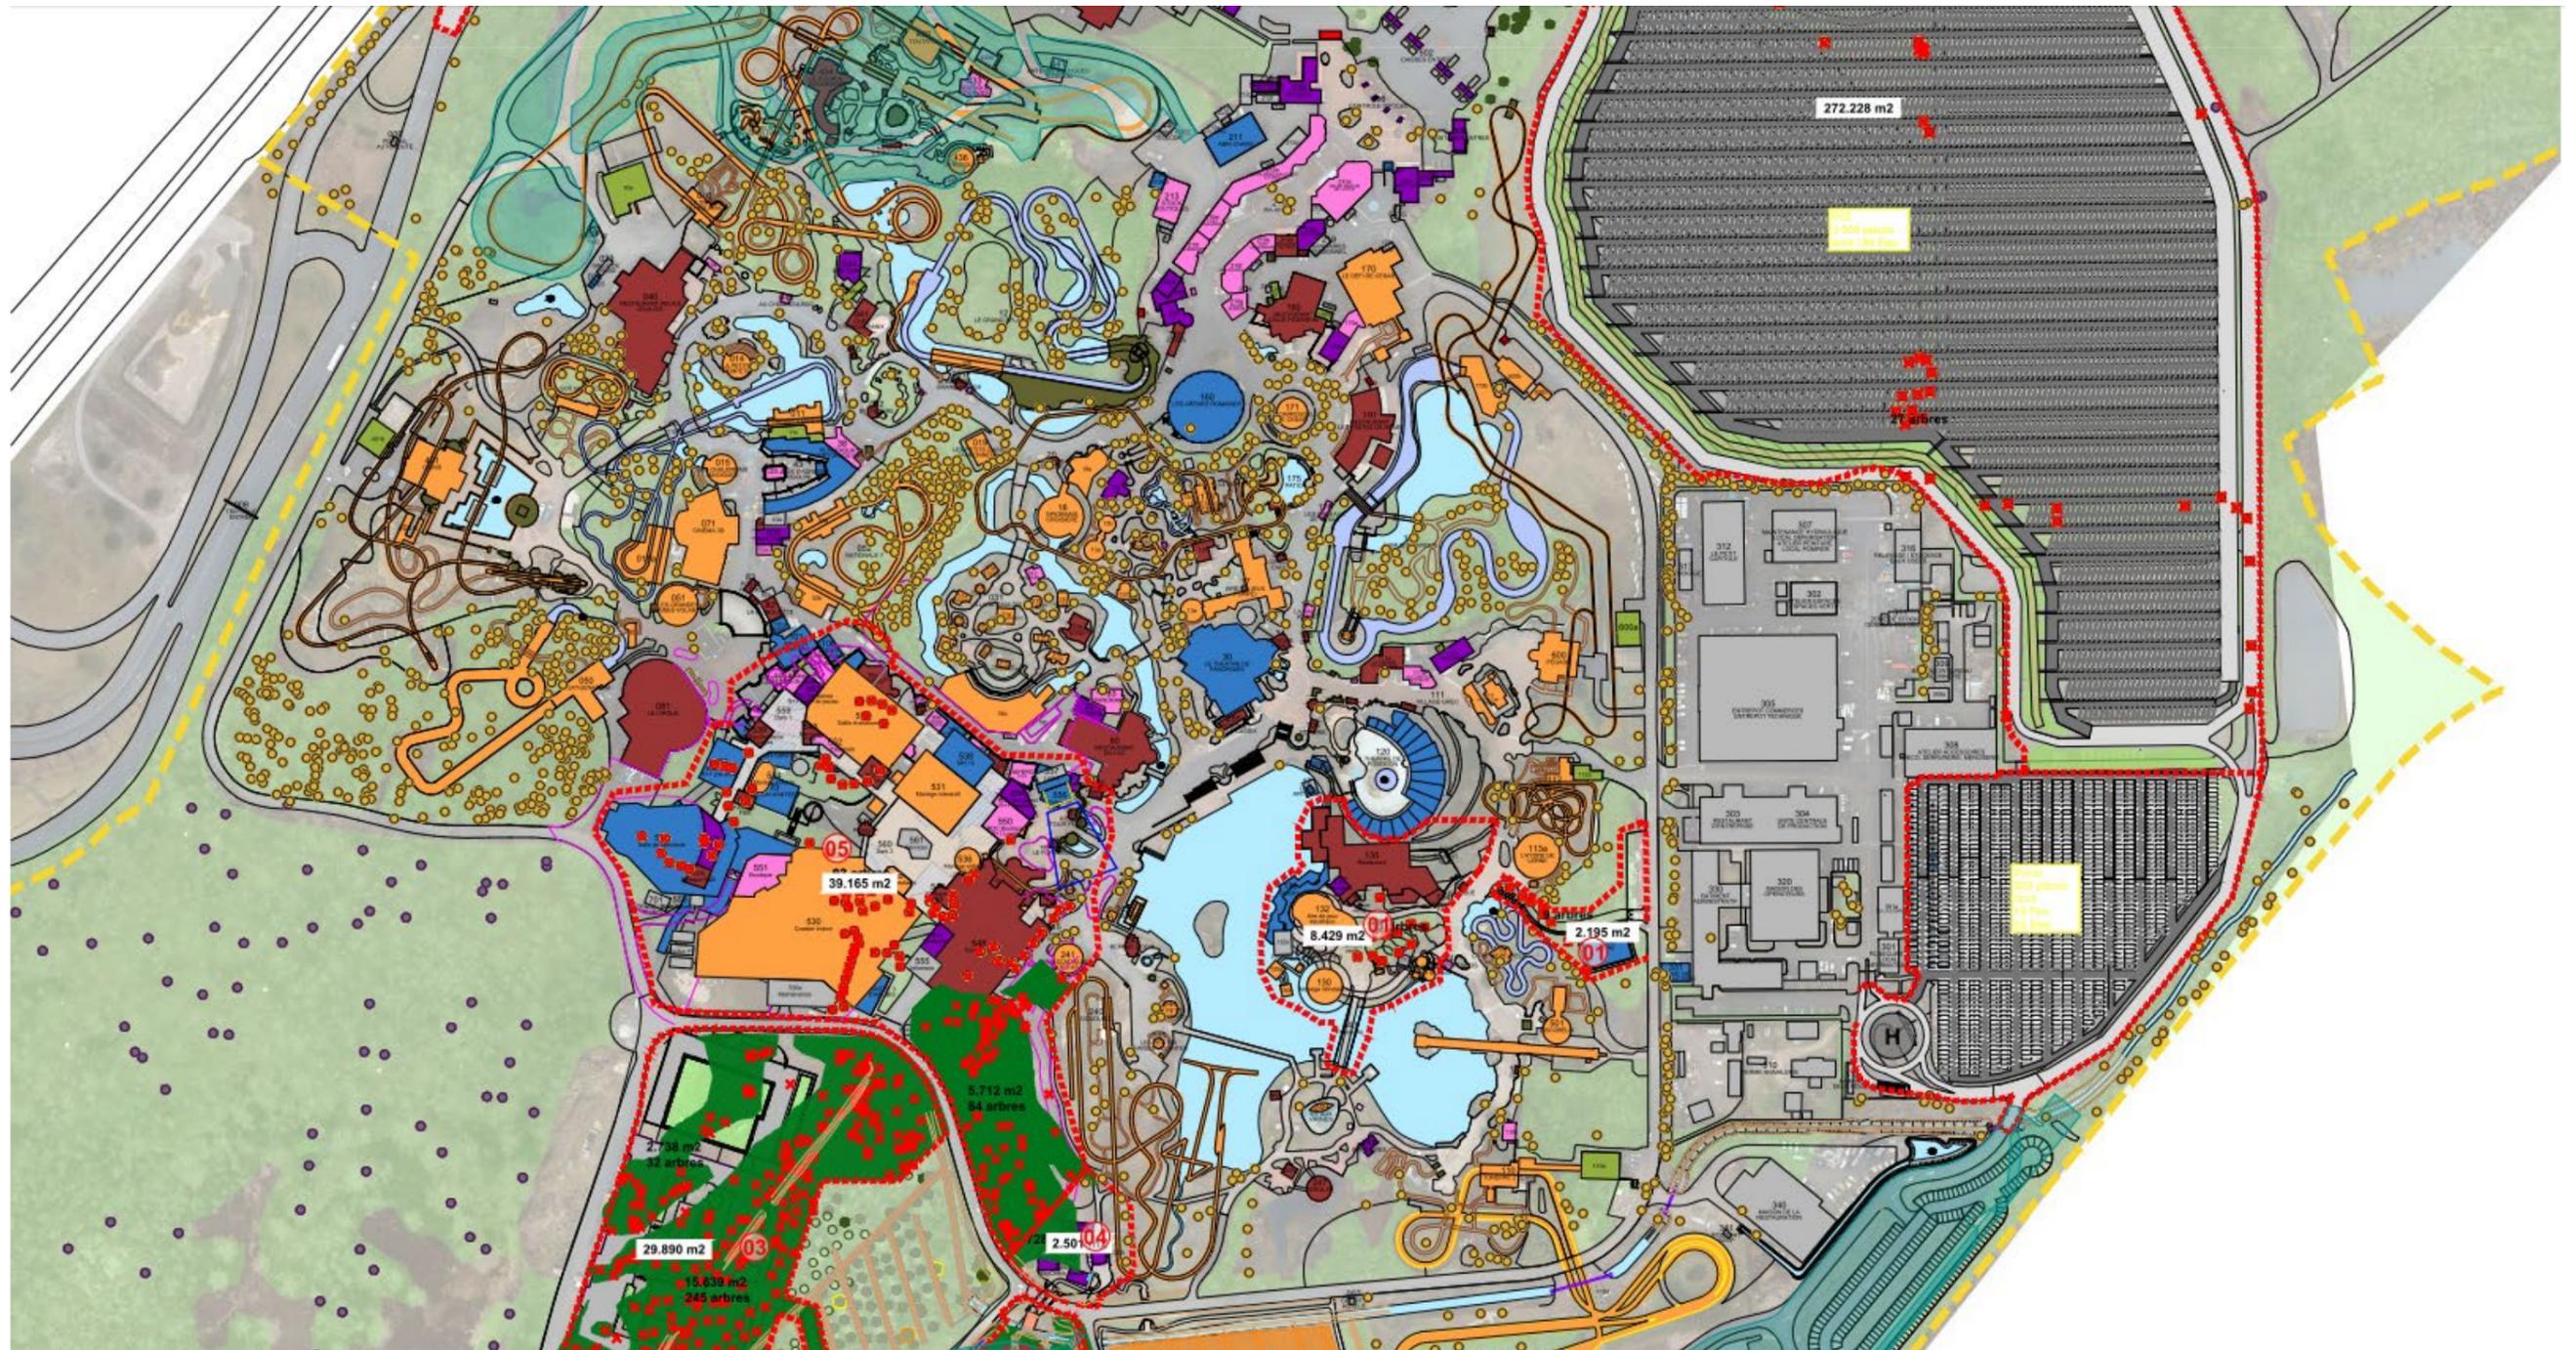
Plan des défrichements – Planche 2 (Parc Astérix)
